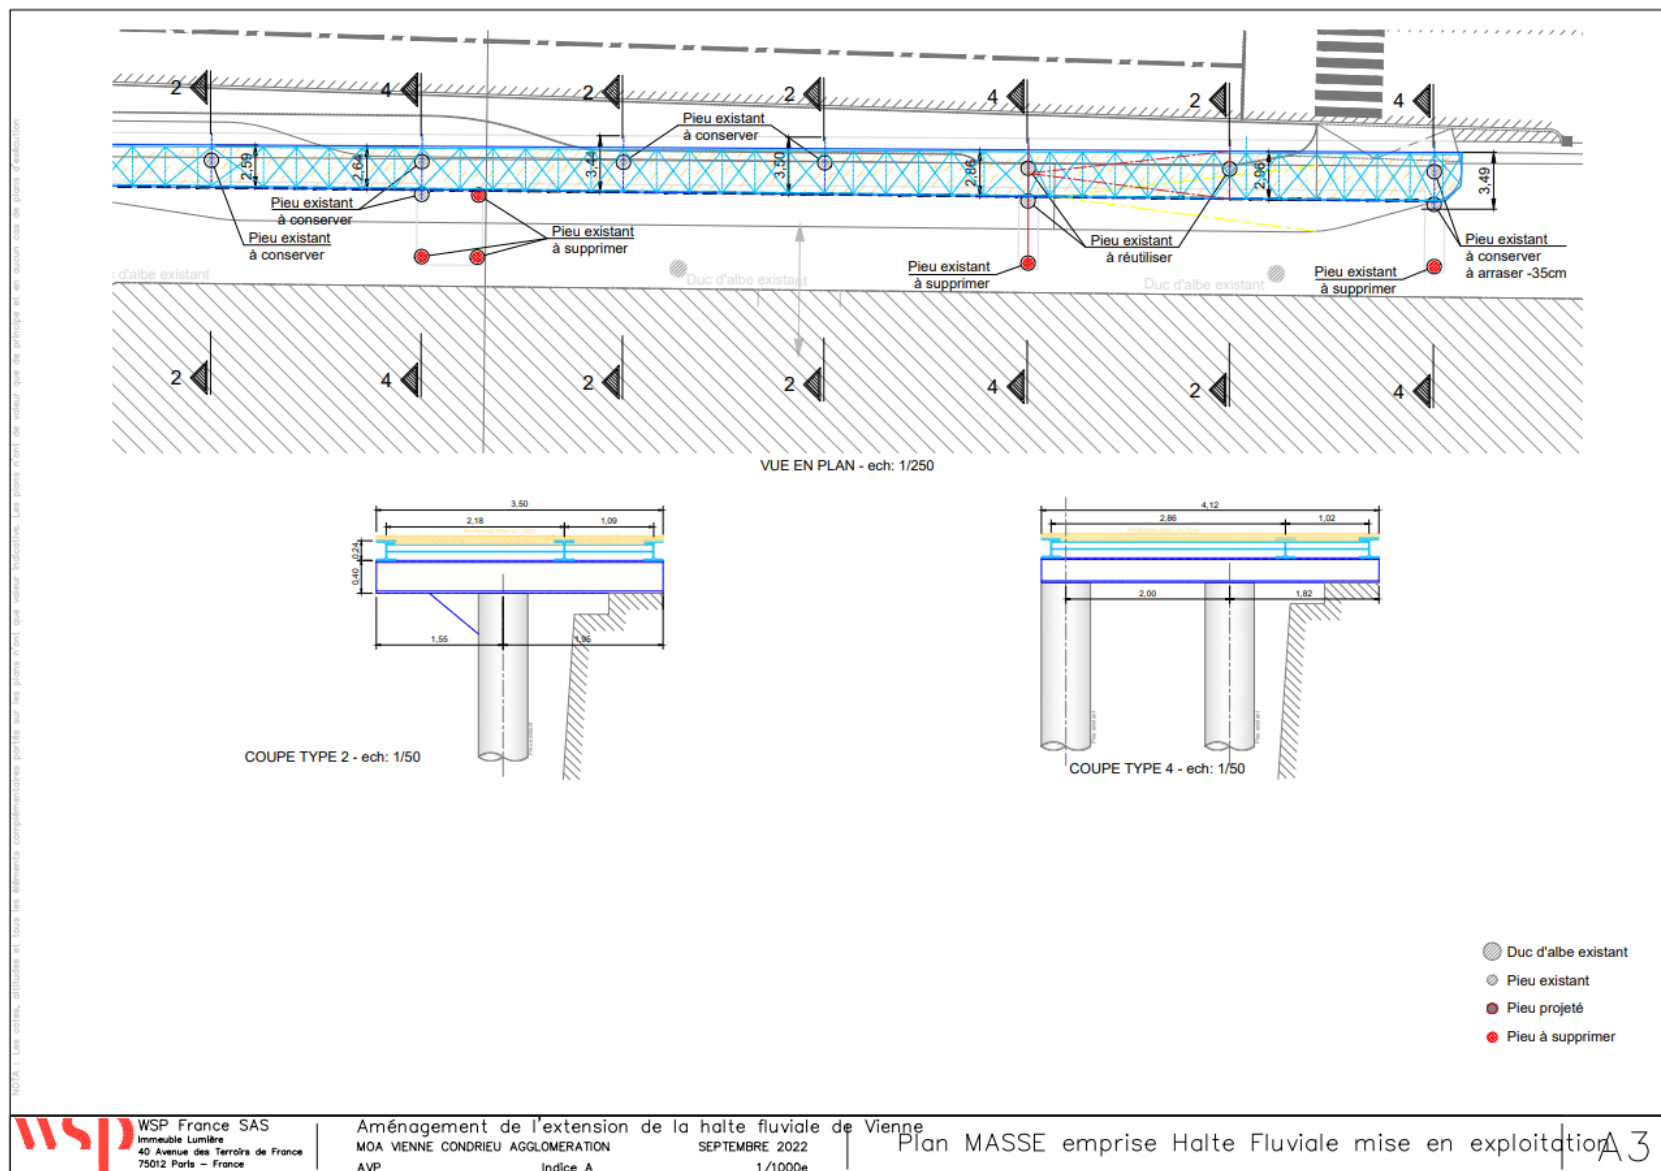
Plan masse et coupes emprise halte fluviale (4)
